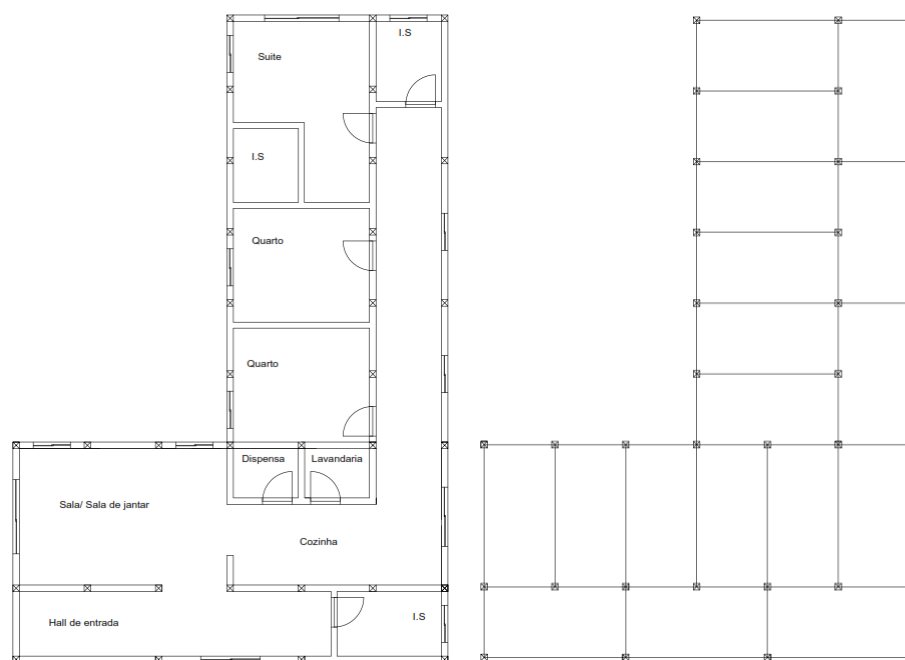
Planta de arquitetura e Planta estrutural, Solução 1, 1º piso
